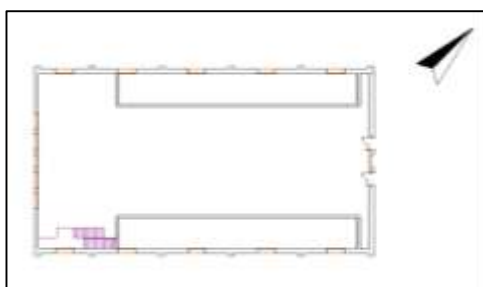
Plan état des lieux du rez-de-chaussée du bâtiment viticole/Source : auteur, 2025
